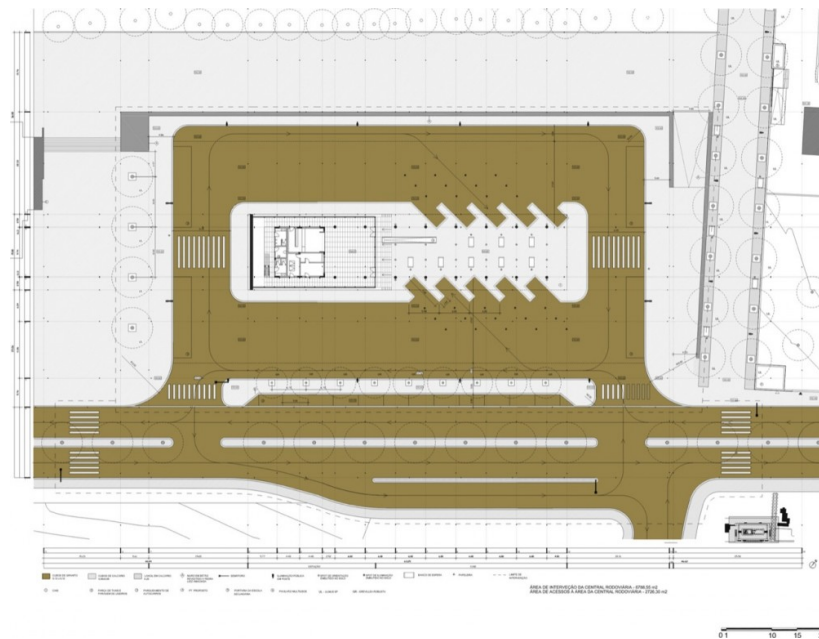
Planta Baixa com acessos ao Terminal Rodoviário de Rio Maior.
